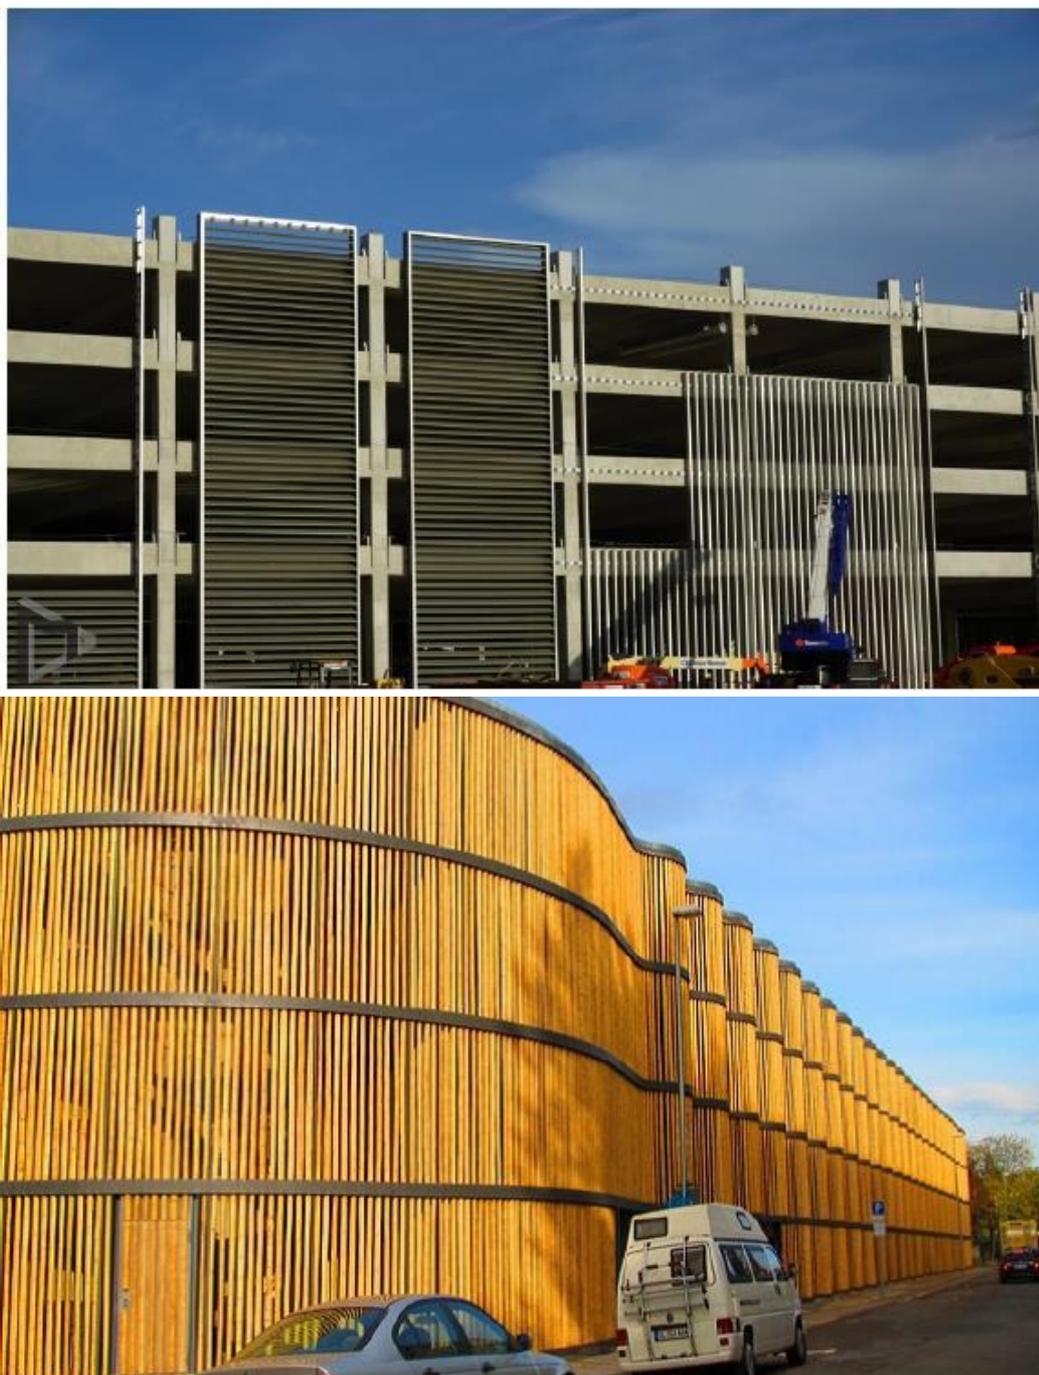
Фасад жалюзи. Горизонтальное и вертикальное расположение реек на фасаде паркинга. Фасад жалюзи на скруглённых поверхностях.
